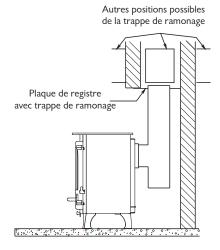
Plaque de registre horizontale avec branchement de conduit de fumée vers le haut
